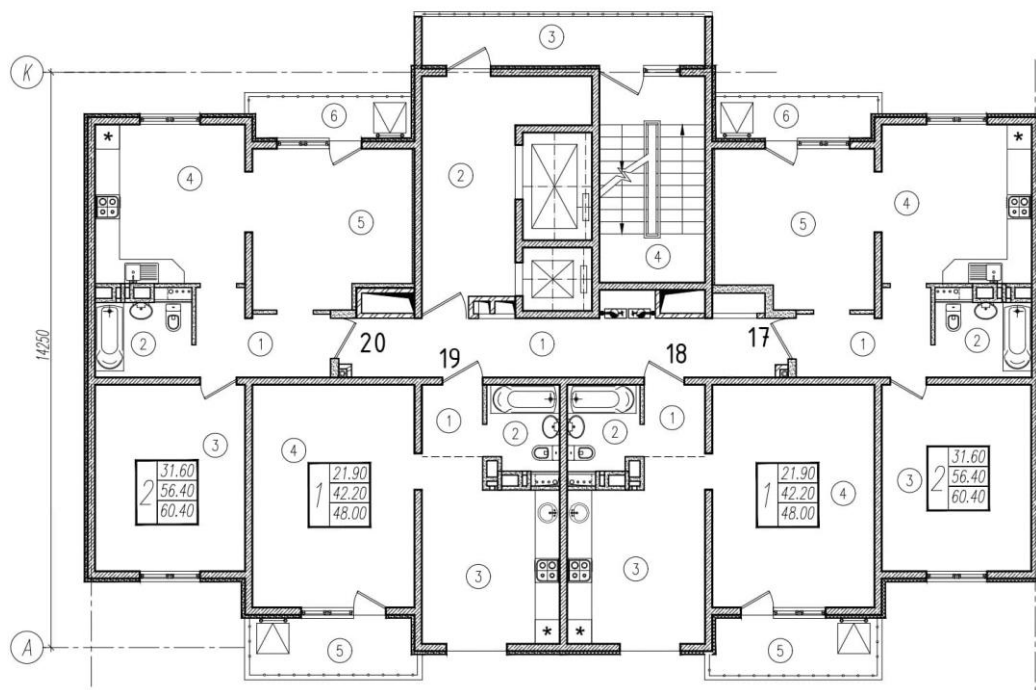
План 6-8-ого этажей 5 литеры ЖК «Горный квартал»
